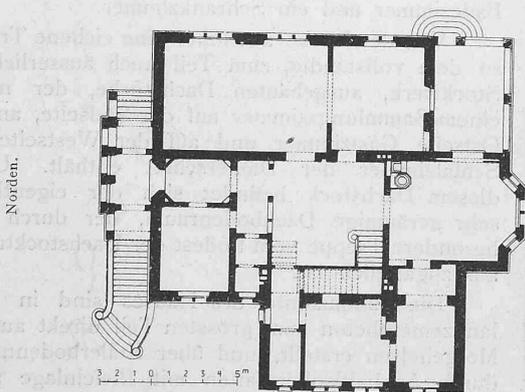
Grundriss vom Erdgeschoss. — Masstab 1 : 400.
